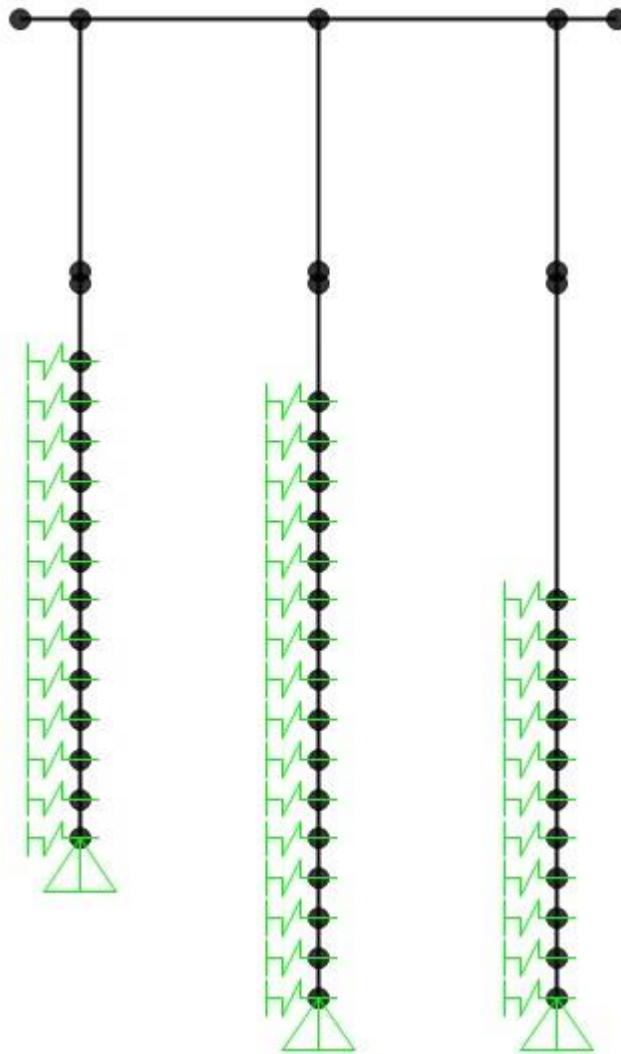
Vista General sin cargas de Pórtico de Apoyo.
